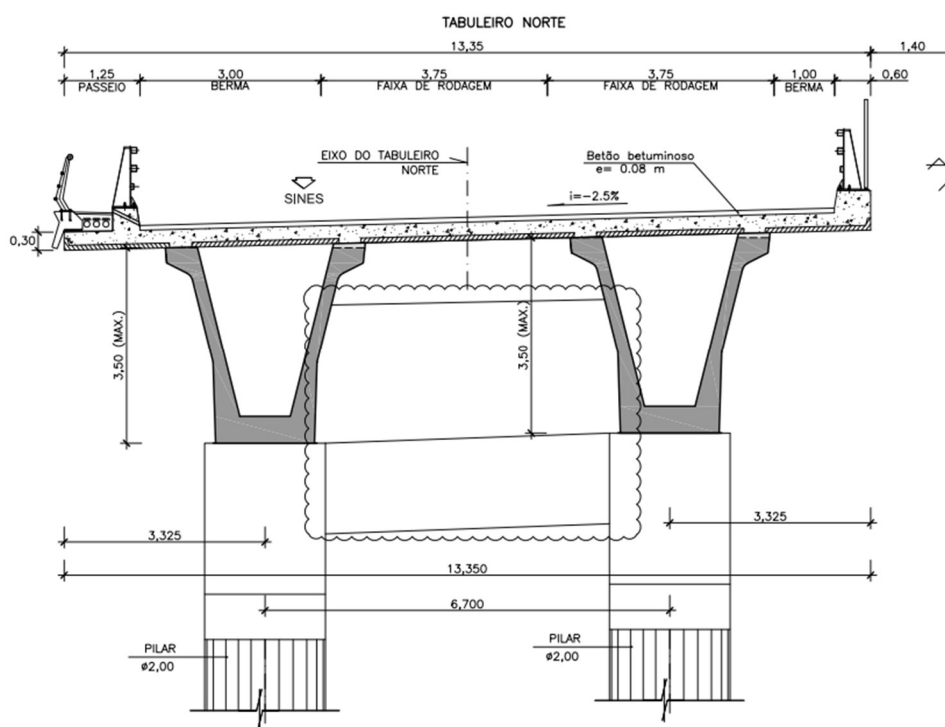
Corte transversal do tabuleiro dos pilares 15 e 16
